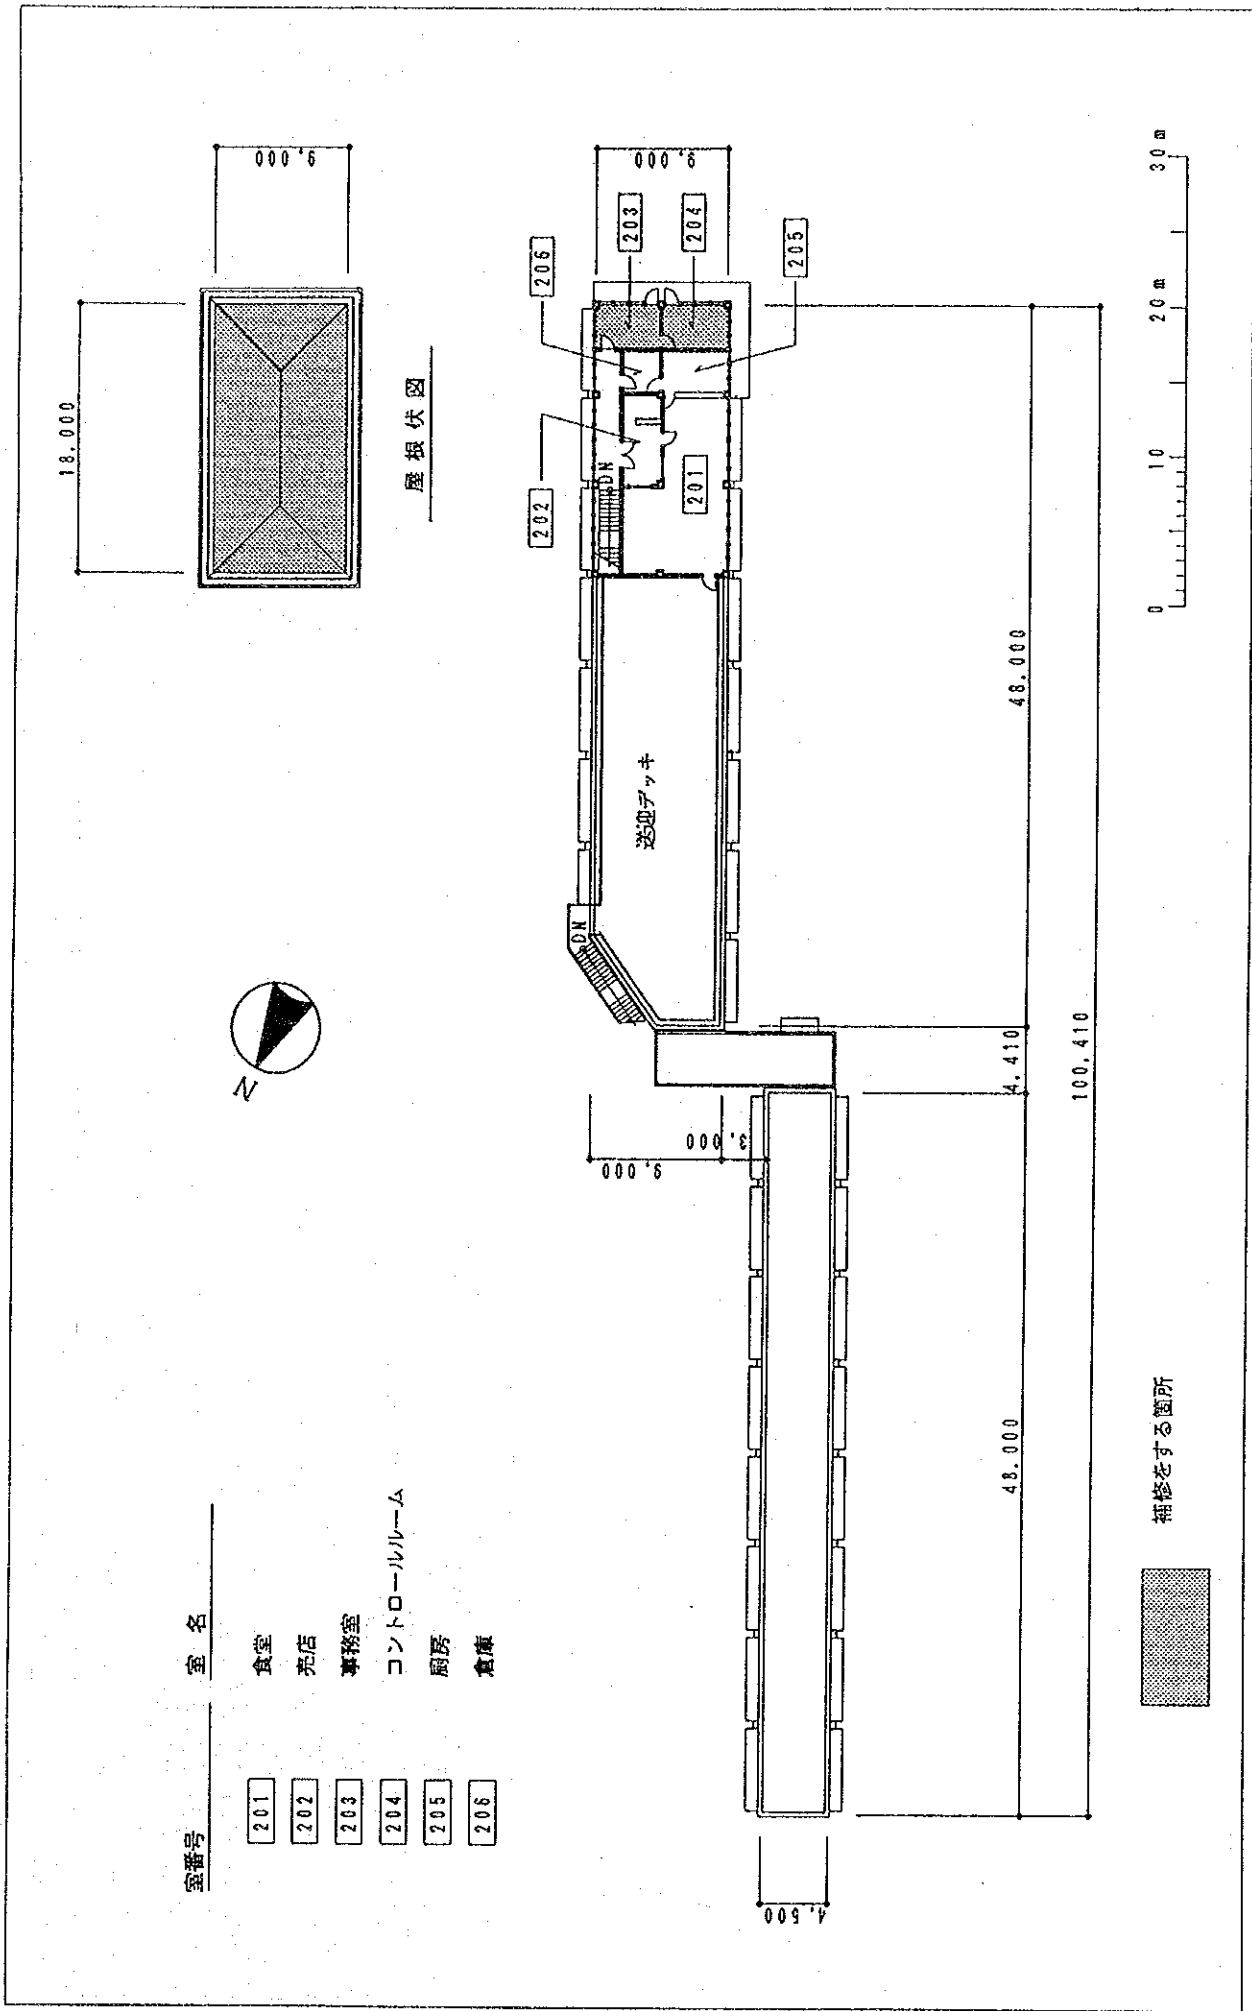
サレログ港 フェリーターミナルビル2階平面図
